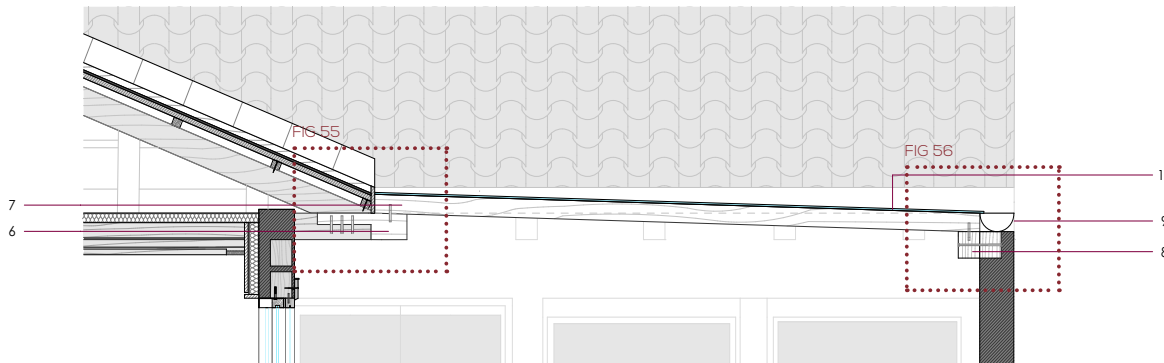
Detalle constructivo 23 | Propuesta, cubierta segundo patio.
